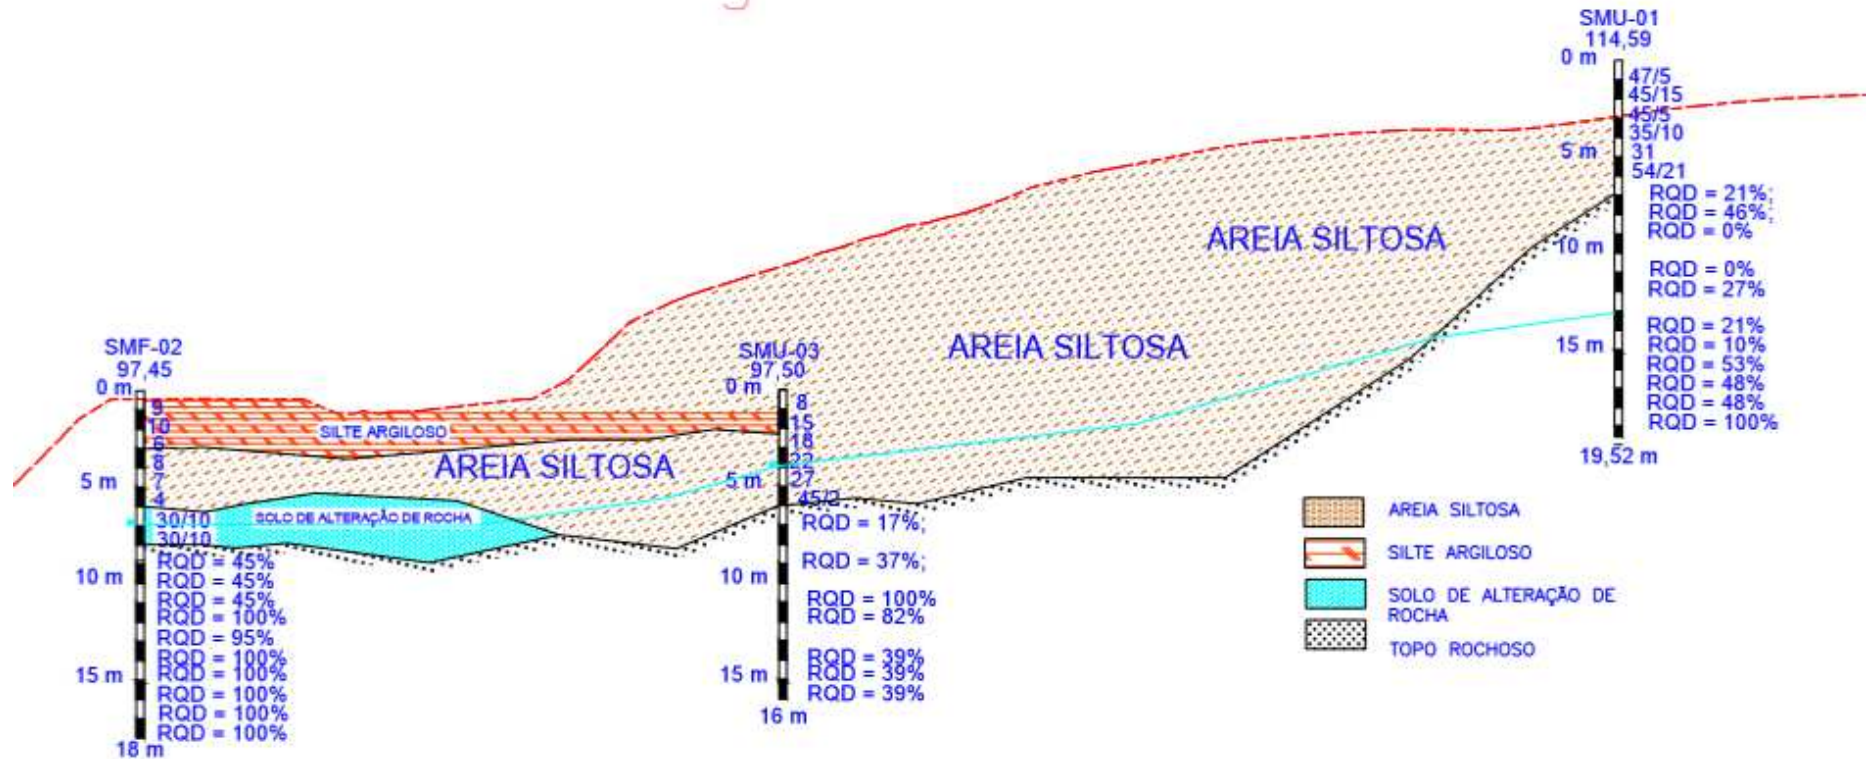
Perfil Geotécnico definido pelas Sondagens Mistas – Seção “DD”
